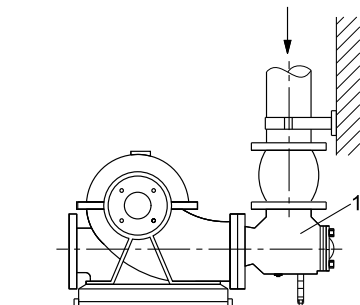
Диффузор (1) во всасывающем трубопроводе
